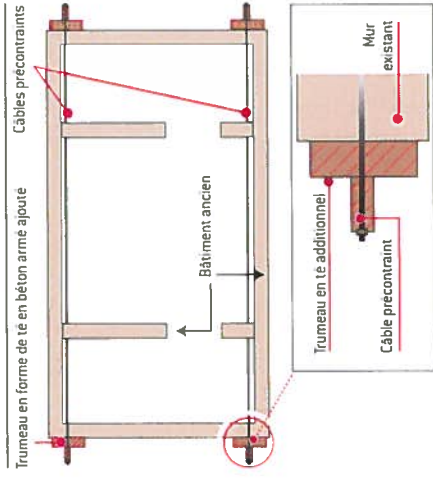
Exemple de renforcement par ajout de murs en béton à l'extérieur + serrage par précontraint (vue en plan)
